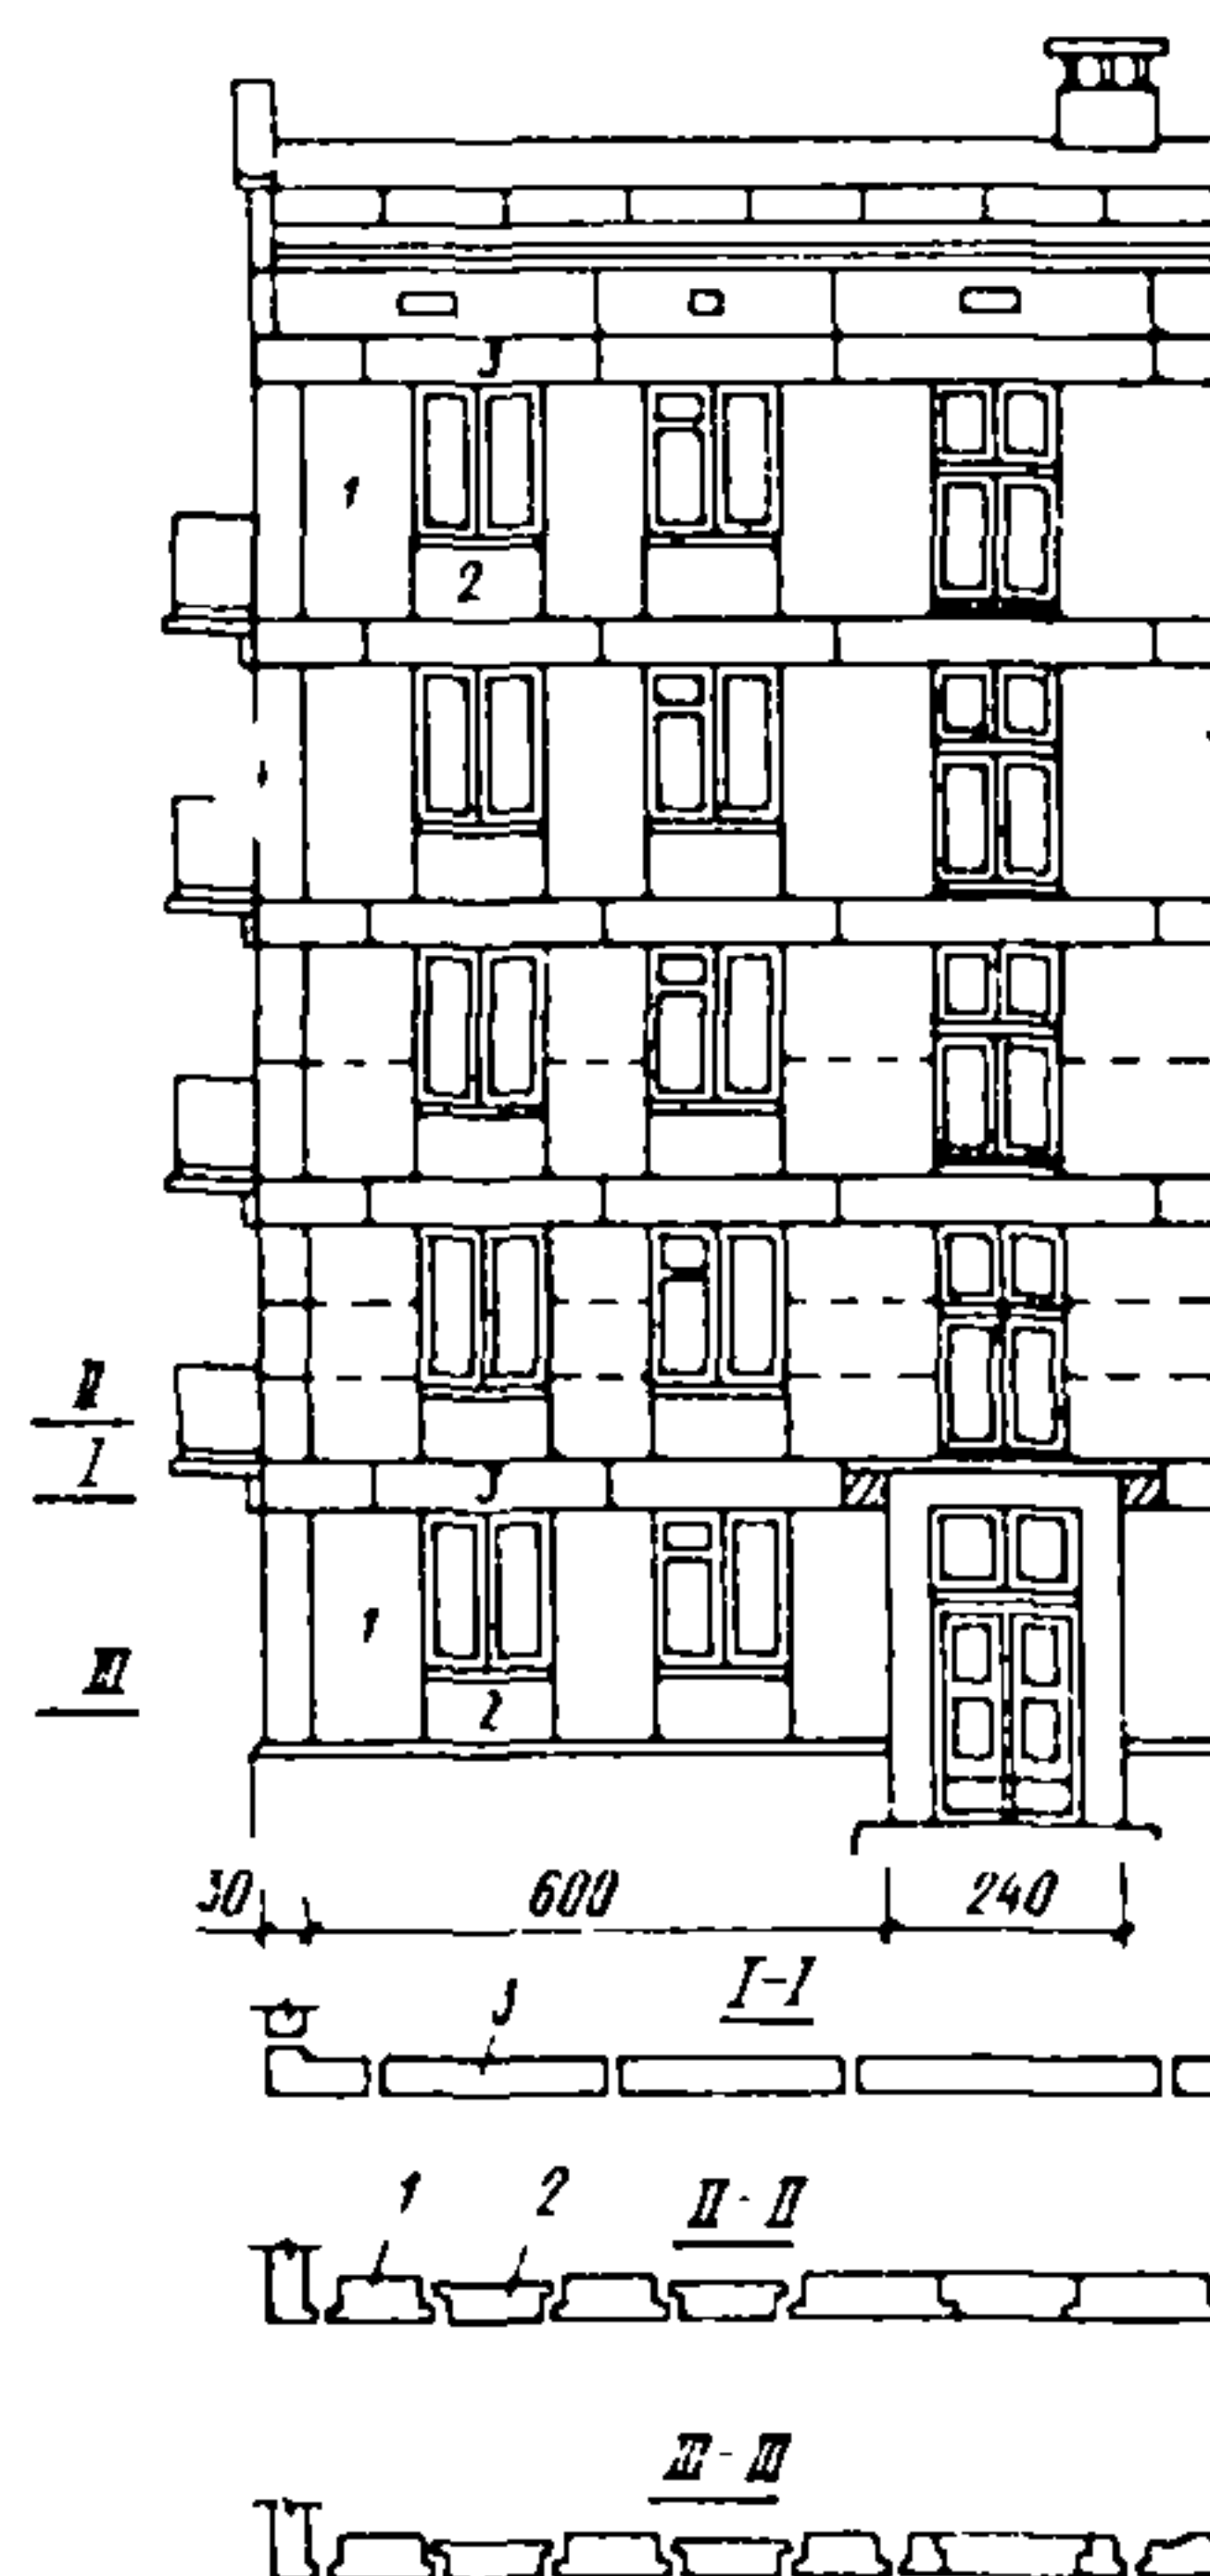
Фрагмент фасадной стены из крупных блоков при двухрядной разрезке
